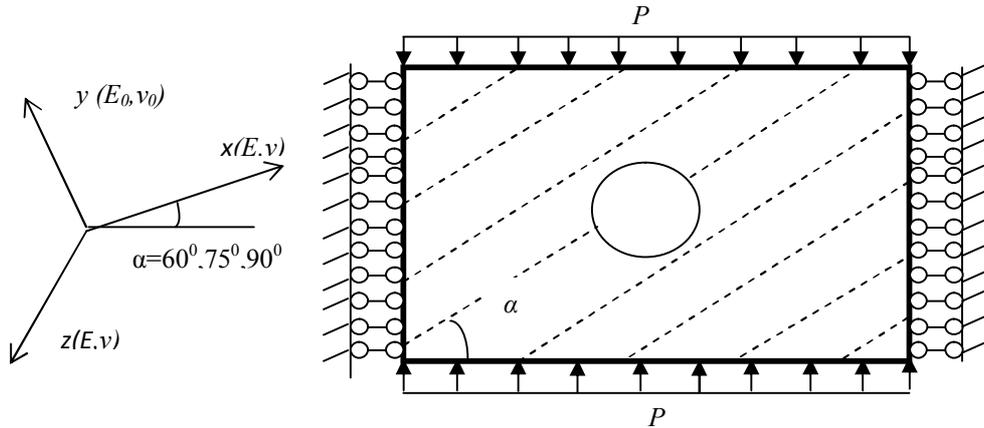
Расчетная схема, моделирующая собственный вес грунта на туннель, по модели трансверсально-изотропной среды (α – угол наклона слоев грунта или плоскости изотропии)
